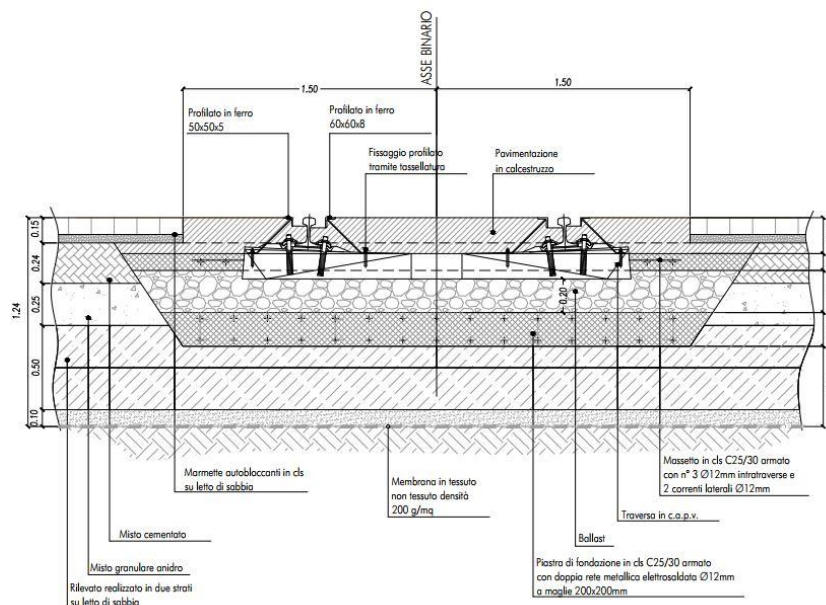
Pacchetti di pavimentazione in progetto – binario carrabile armamento 60UNI
